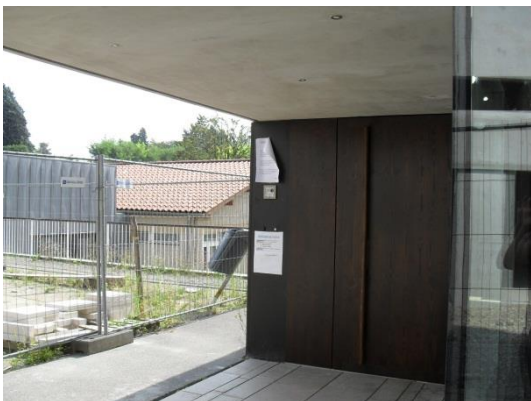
L'ENTREE DE LA CRECHE ET LES TRAVAUX A PROXIMITE.
